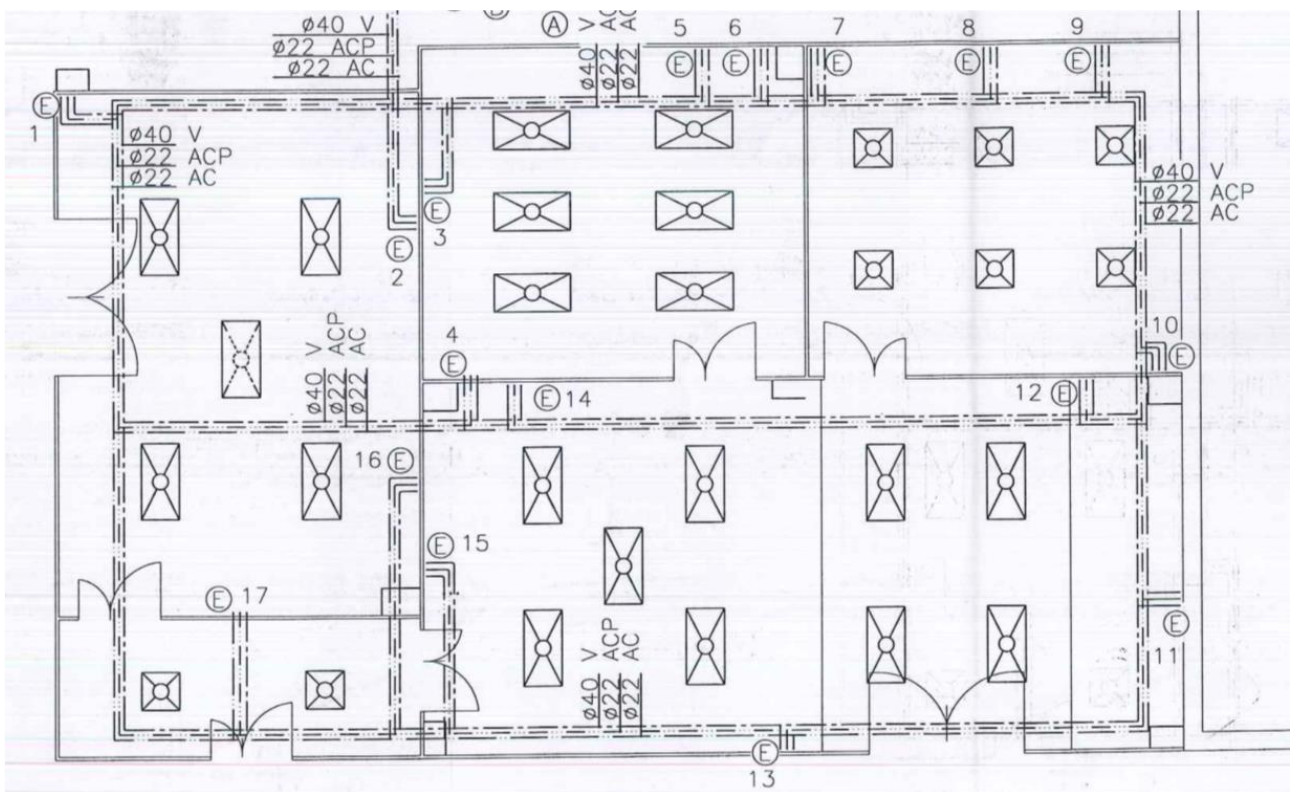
Planimetria della camera bianca della Sezione di Firenze.
